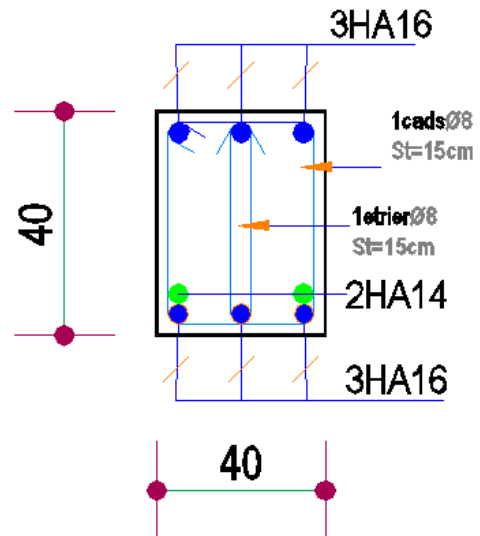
Schéma de ferrailage de la poutre brisée en travée
